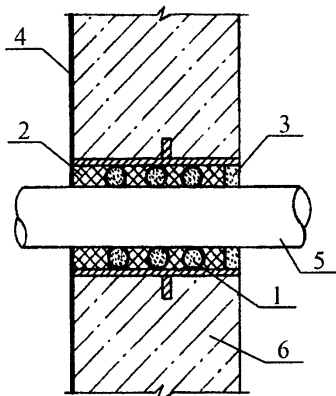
Схема устройства пропуска технологических трубопроводов через гидроизоляцию с набивным сальником
